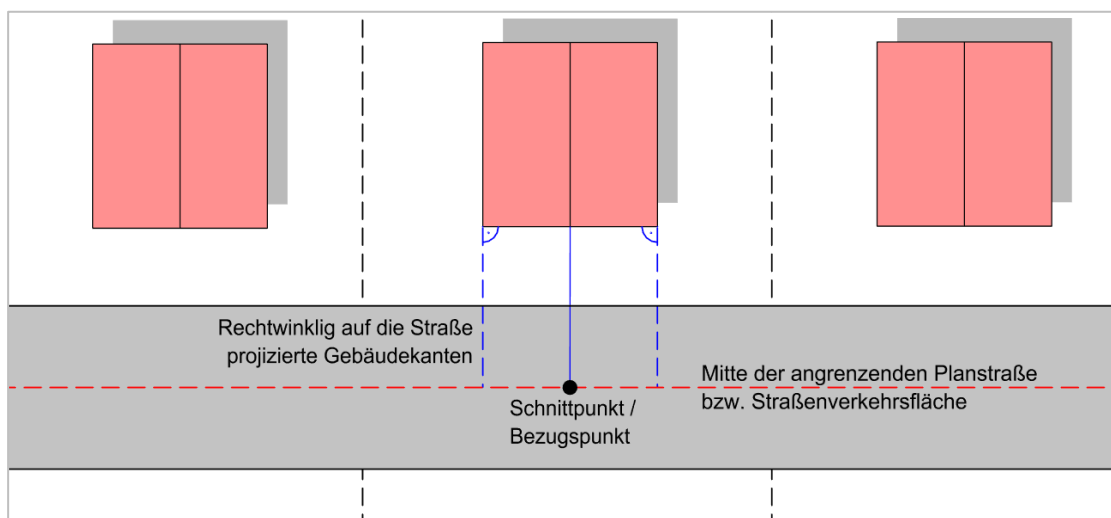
Schema zur Ermittlung der Höhenbezugspunkte; Abbildung unmaßstäblich
